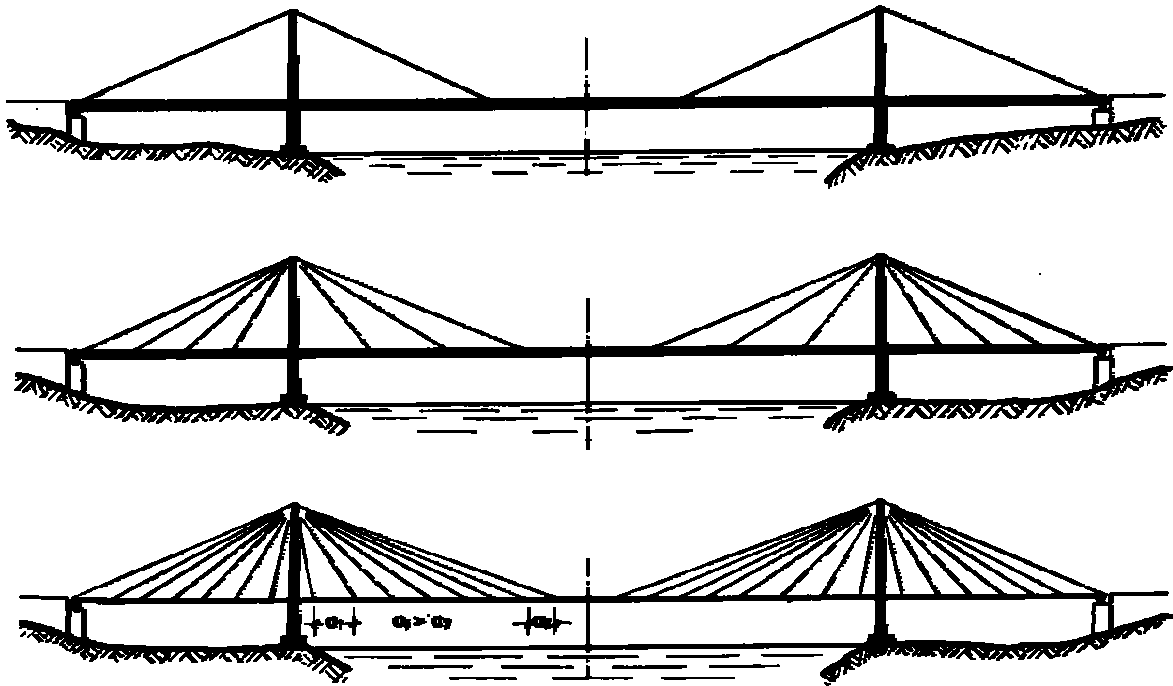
Développement de la poutre mono - haubanée au système multi - haubané
